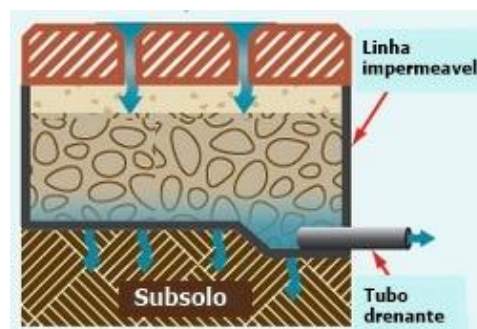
Pavimento permeável de armazenamento (adaptado de <http://www.paveshare.org/library/picp-design-sizing>)
